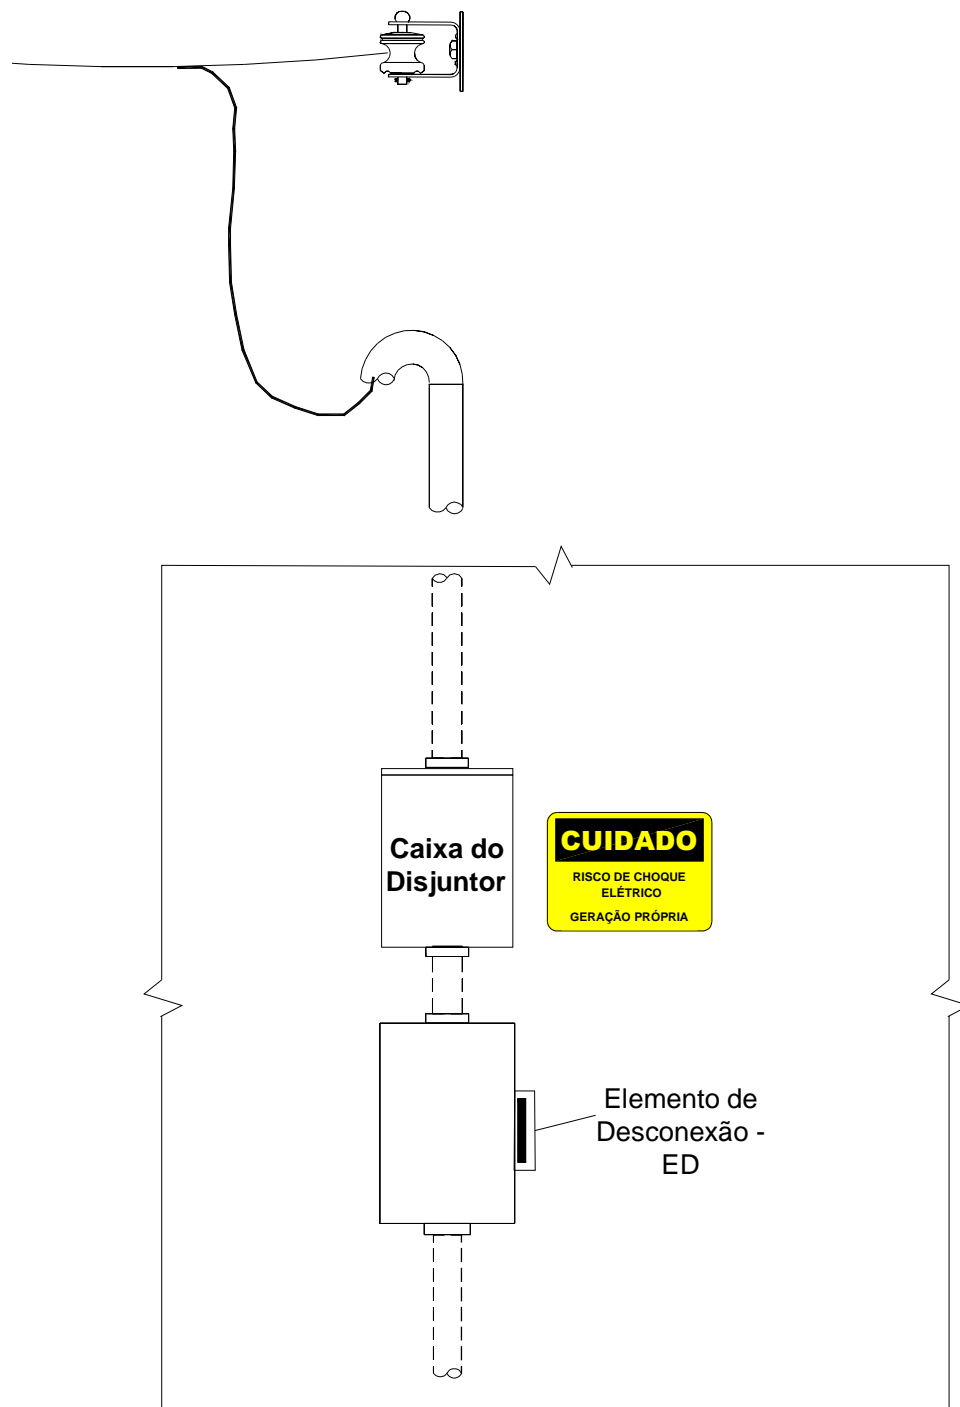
Disposição do Elemento de Desconexão - ED - instalado junto à proteção no padrão de entrada em muro ou mureta - com a medição externa no poste da RD
